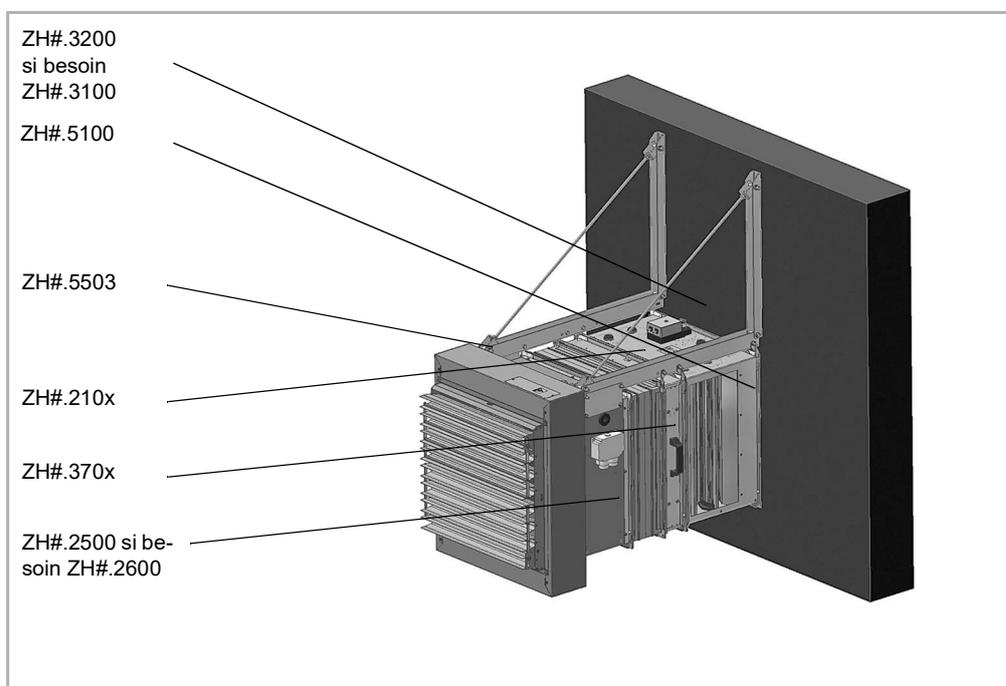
Montage mural d'un appareil de mélange avec accessoires et support « modulaire » (ZH#.5503)
